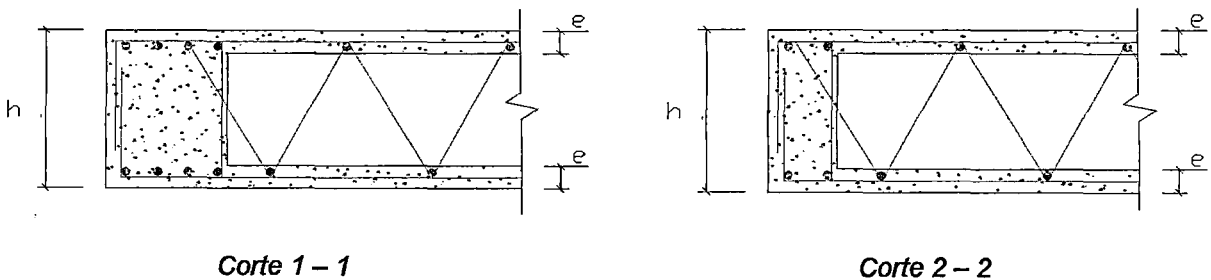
Detalles Típicos de una Edificación que emplea Tridilosa (Estructuración C)
